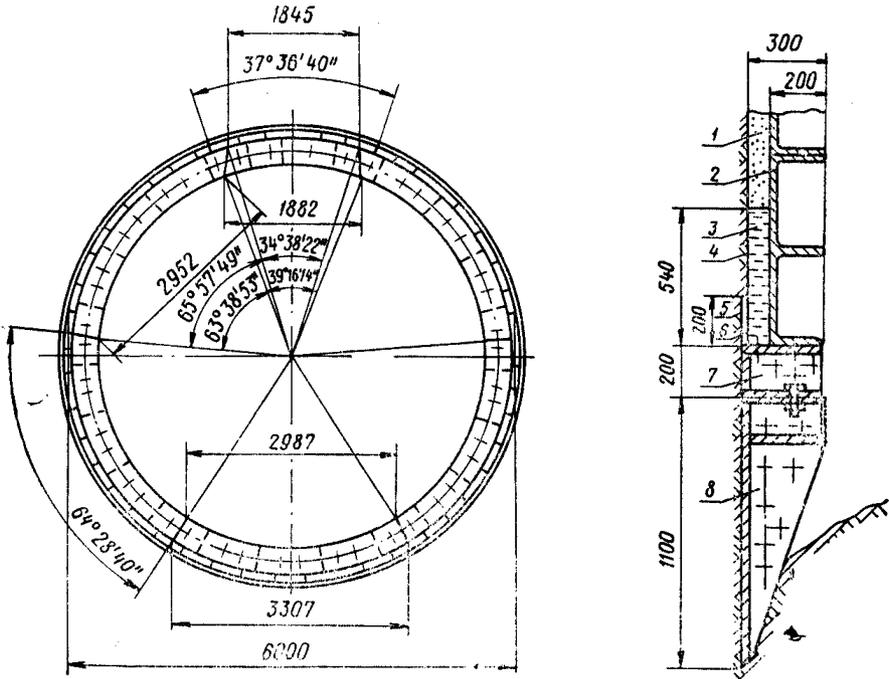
Конструктивная схема ножевого и уплотняющего кольца:
